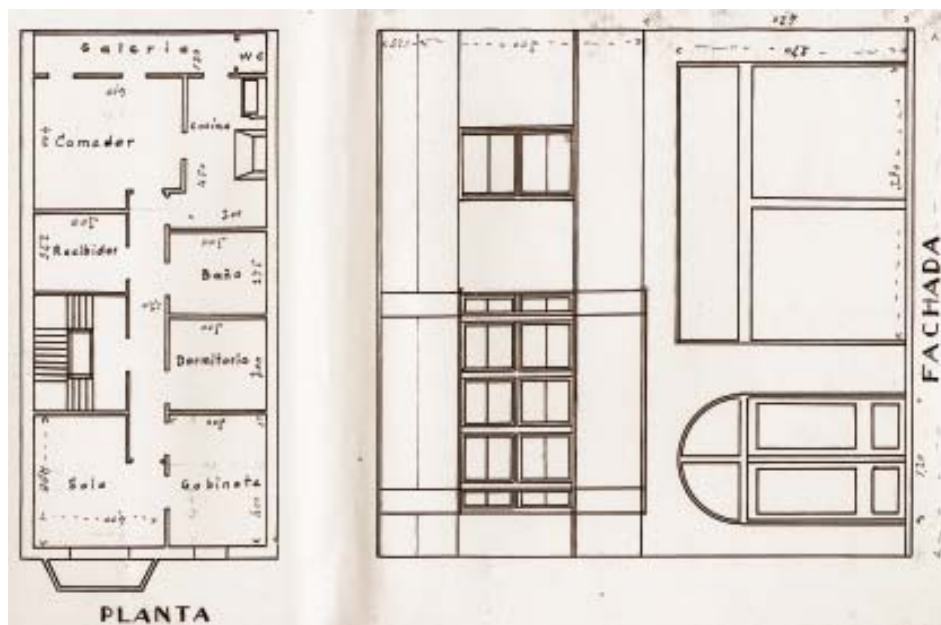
Planta de piso y fachada principal de la casa de Francisco Raposo Villanueva en rúa do Rollo, Betanzos, 1938.
